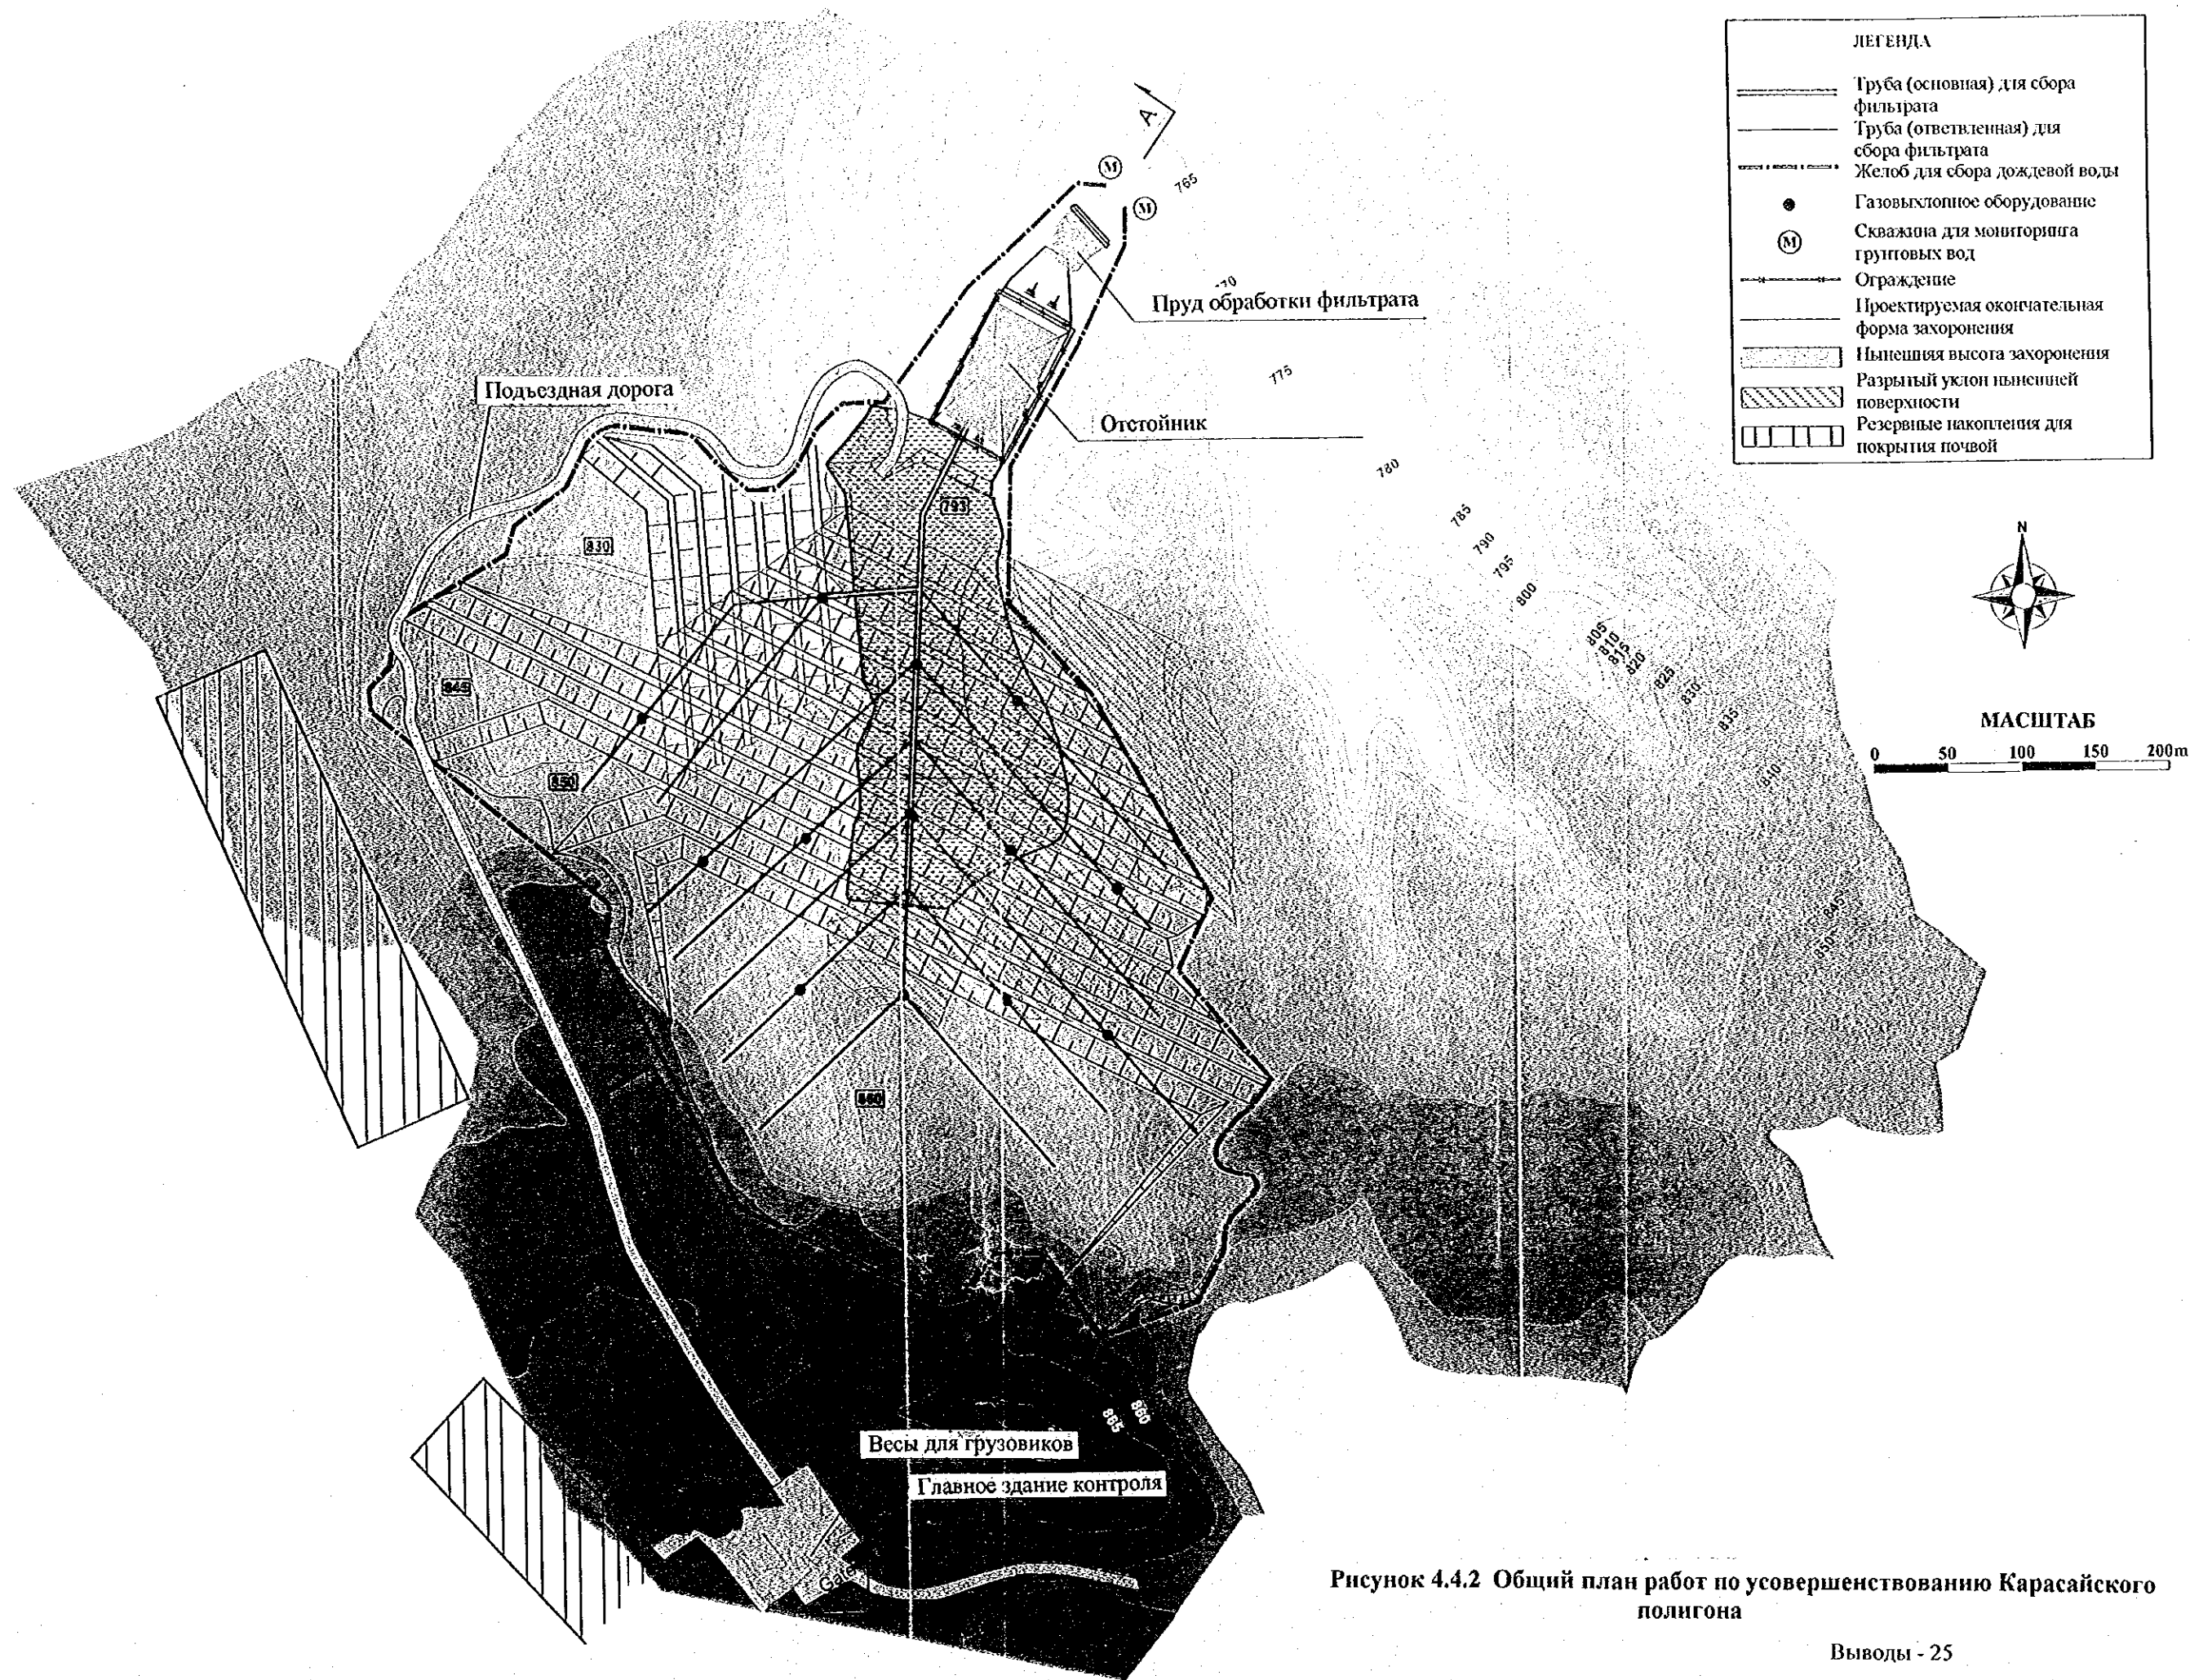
Общий план работ по усовершенствованию Карасайского полигона
